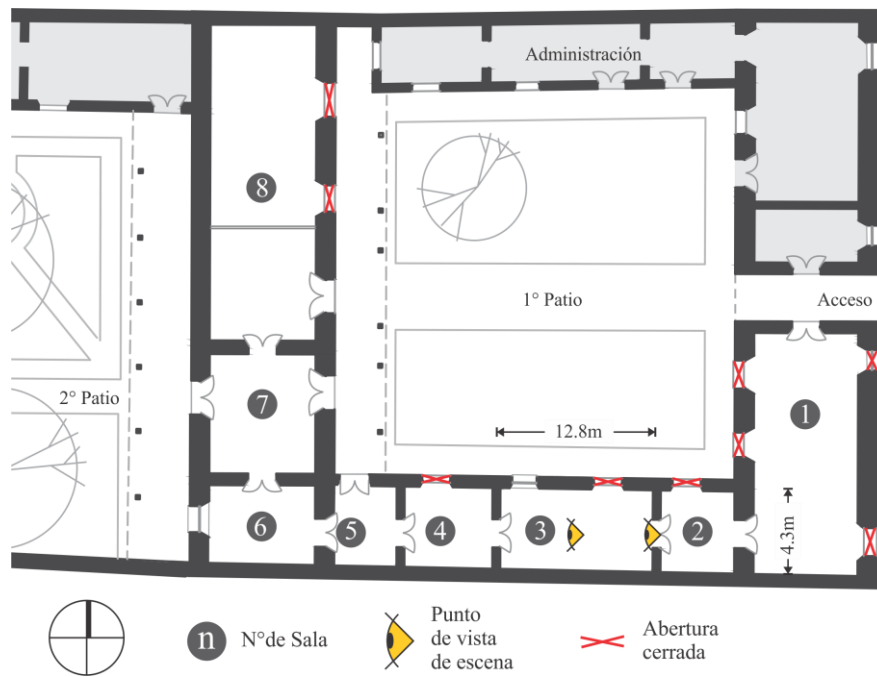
Puntos de vista de escenas de figuras 2 y 3 indicados en la planta del museo CHI.
